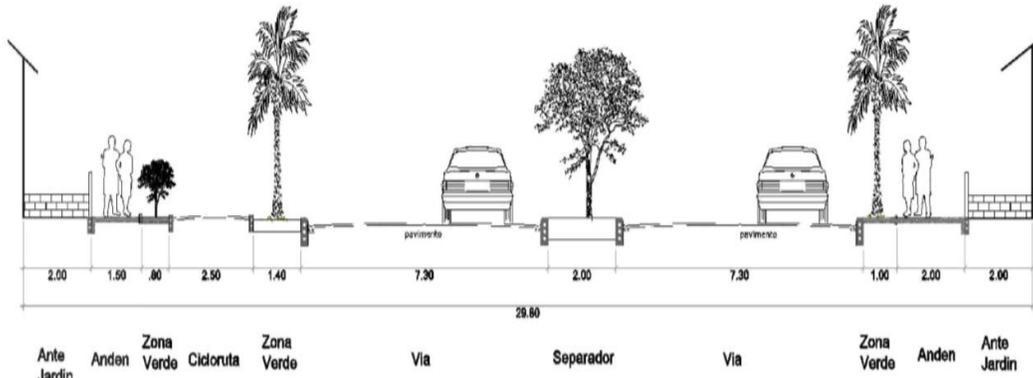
Perfil vial doble calzada tipo 2 carrera 16
